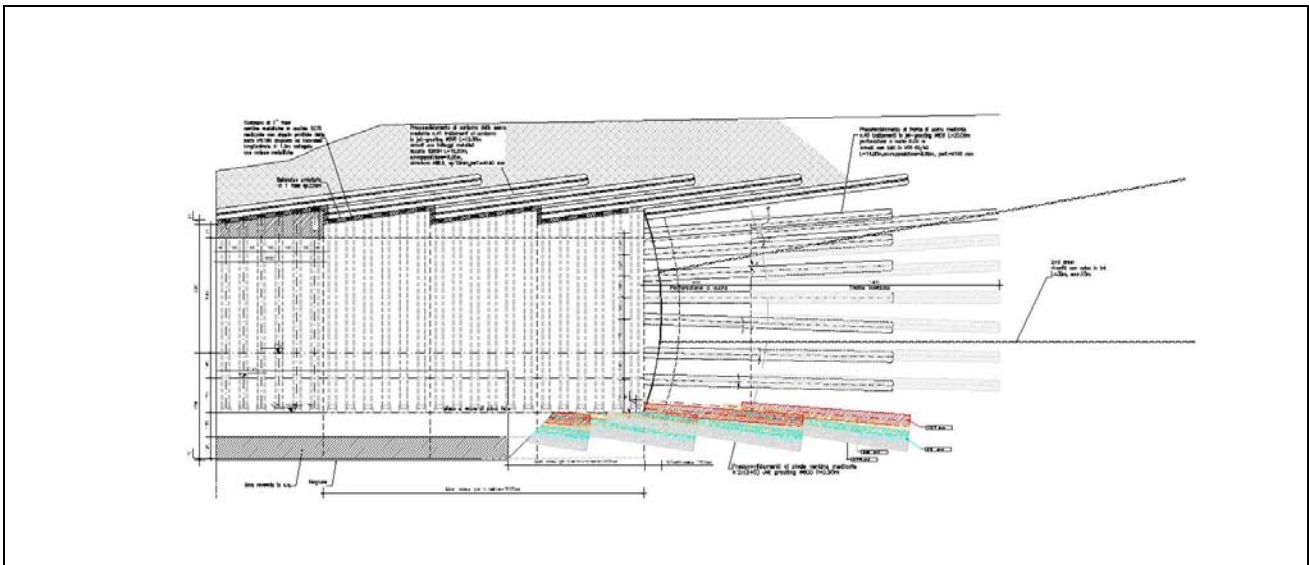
Sezione di scavo tipo GD-C2 - Sezione longitudinale
